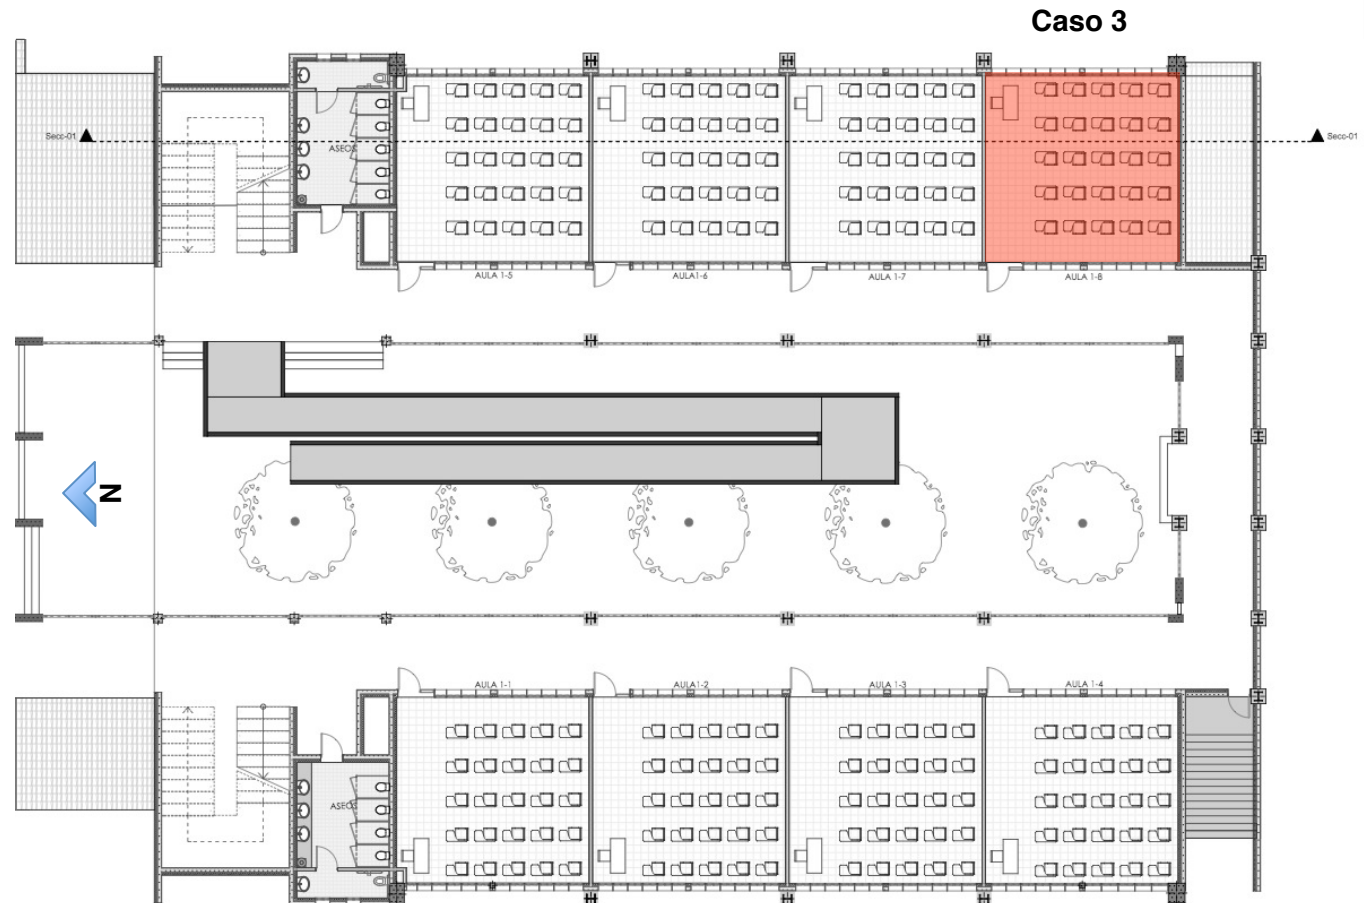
Planta centro docente (Fuente Constructora Daneri).
